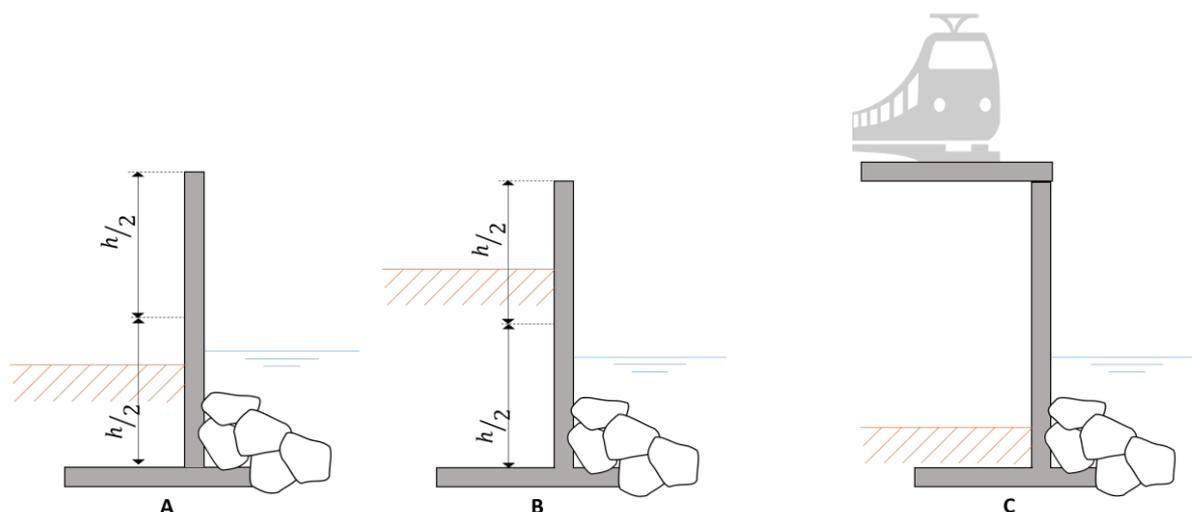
Classification d'un mur : A : mur [de protection contre les crues] ; B : mur de soutènement de la rive ; C : mur de soutènement de la rive.
